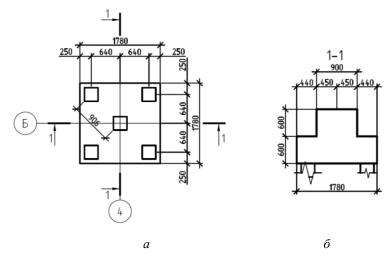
Скорректированная схема расположения свай (a) и поперечный разрез ростверка (δ)
